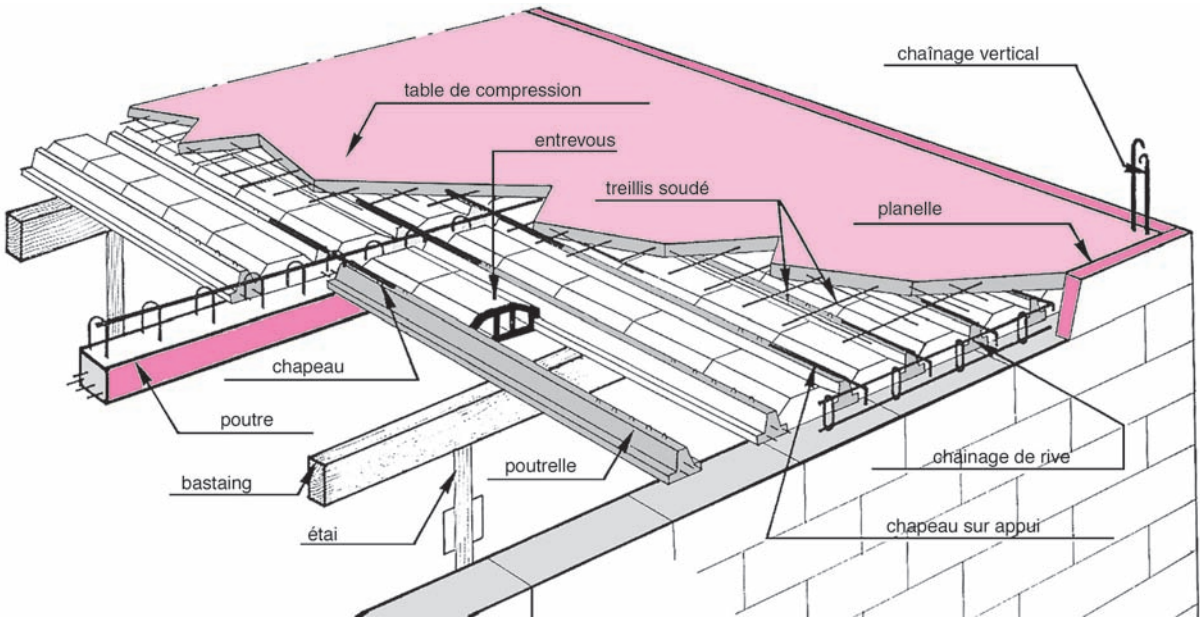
Schéma d'ensemble de la mise en œuvre d'un plancher classique à poutrelles
